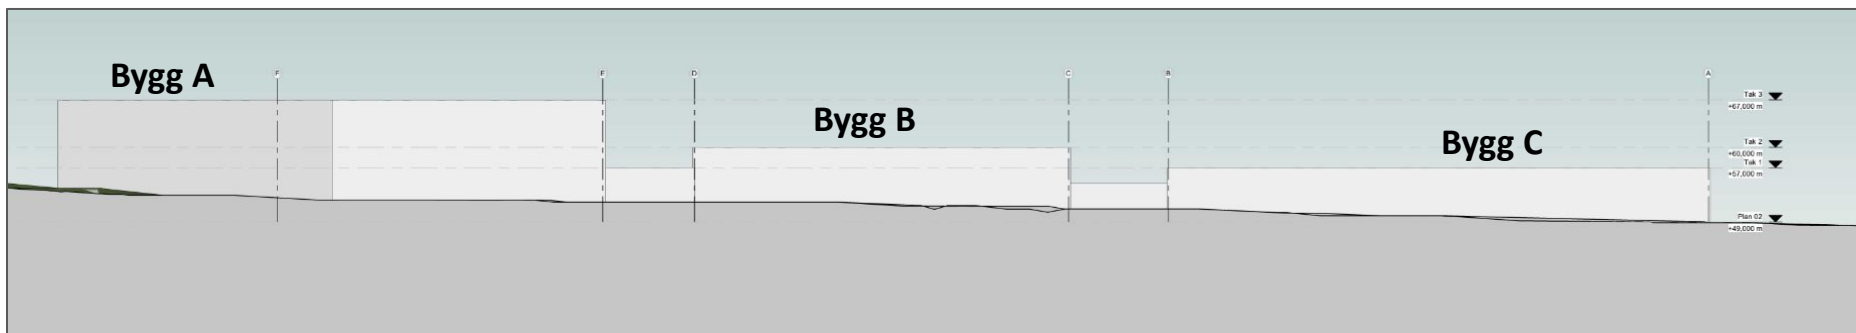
Snitt med mulig bebyggelse, sett fra øst. Kochhaugvegen til venstre, og E6 til høyre.
